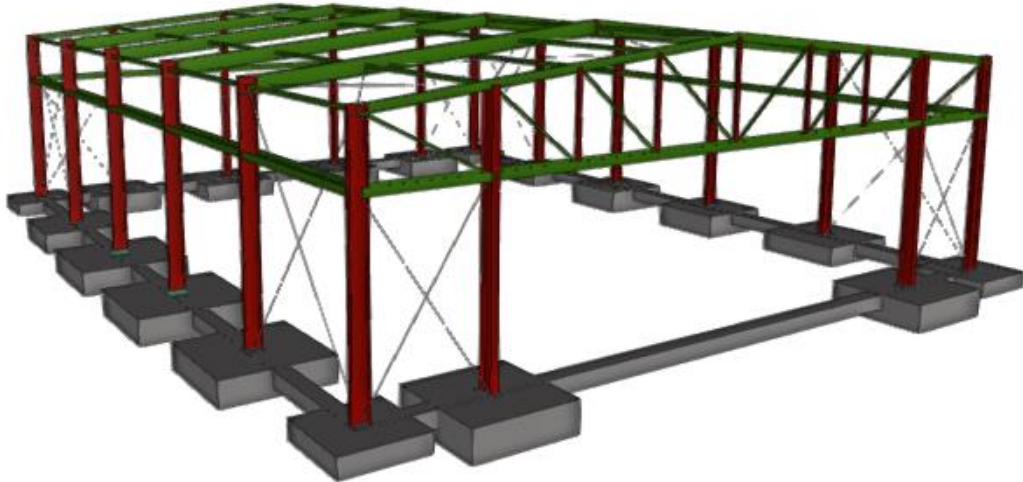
Modelo 3D de la estructura y la cimentación.
